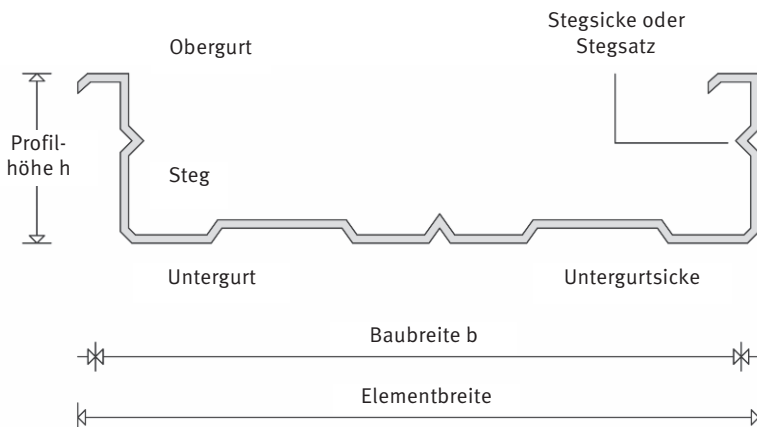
Bezeichnungen an Kassettenprofilen nach Änderung A1 zu DIN 18807-1
